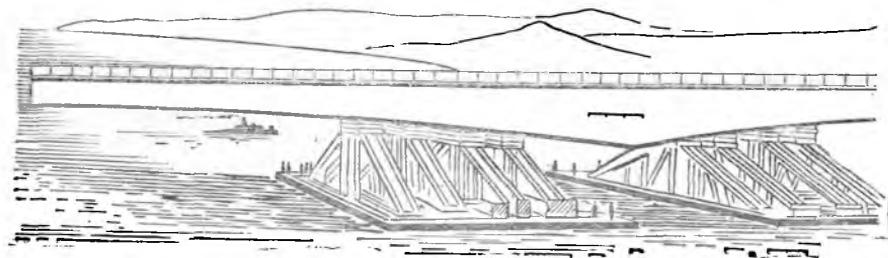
Схема погрузки на плавучие опоры железобетонной балки: 1 — пирс; 2 — пролетное стропило; 3 — надстройка; 4 — распределительная ферма; 5 — плашкоут
